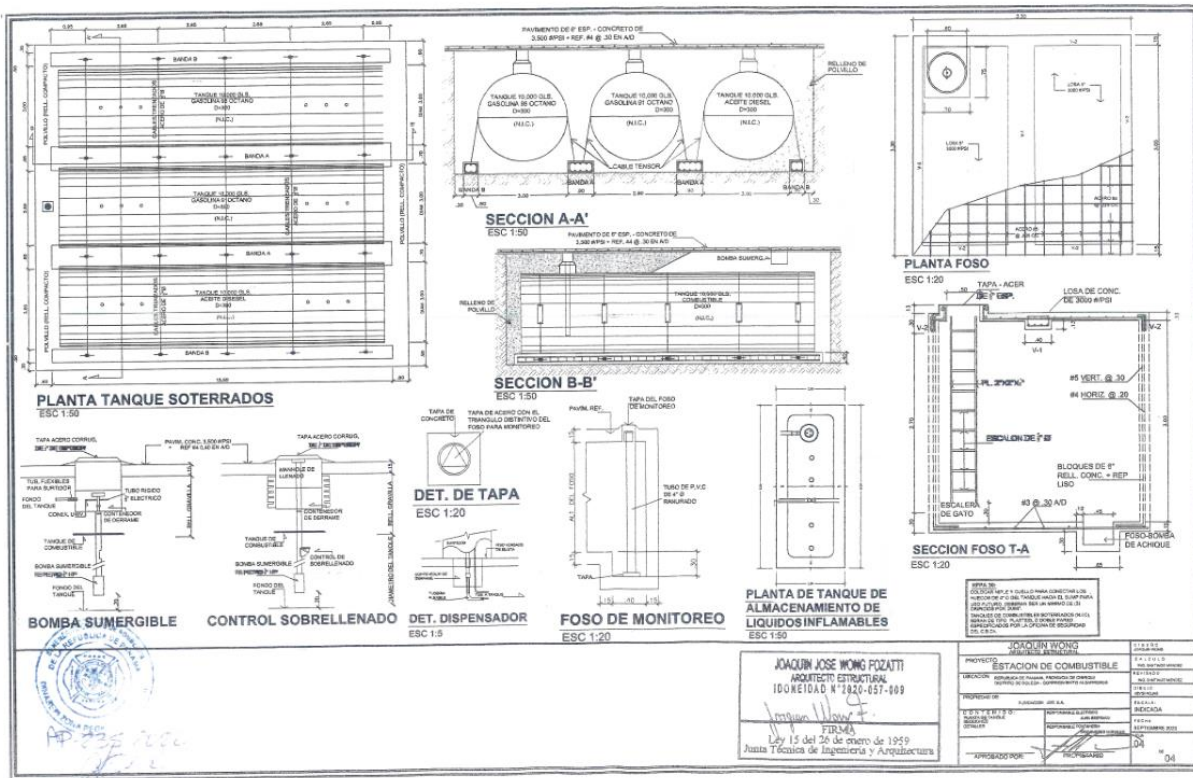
Planta arquitectónica y detalles de Tanques de Almacenamiento
